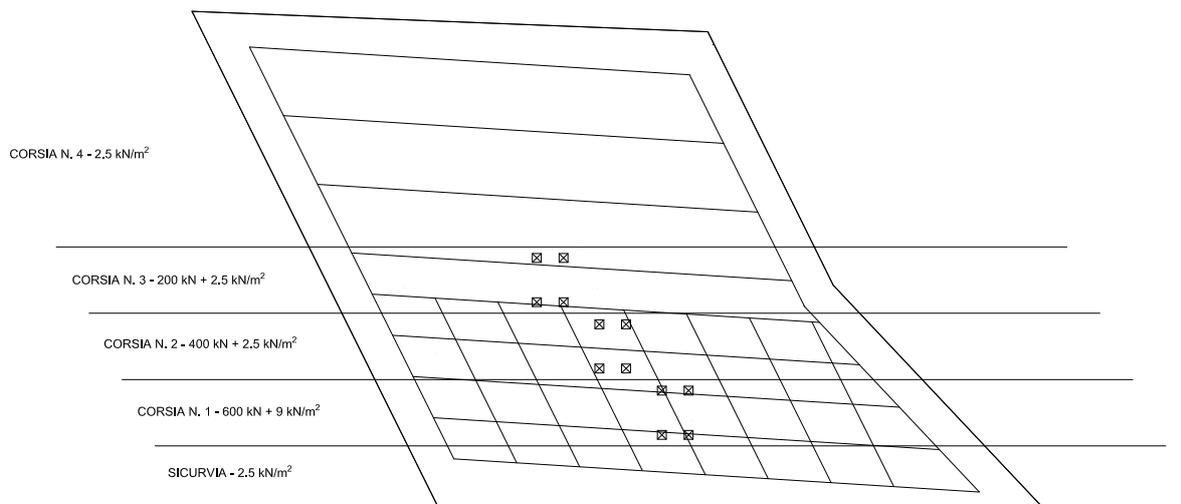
Disposizione carico tandem per massimo momento impalcato di progetto
